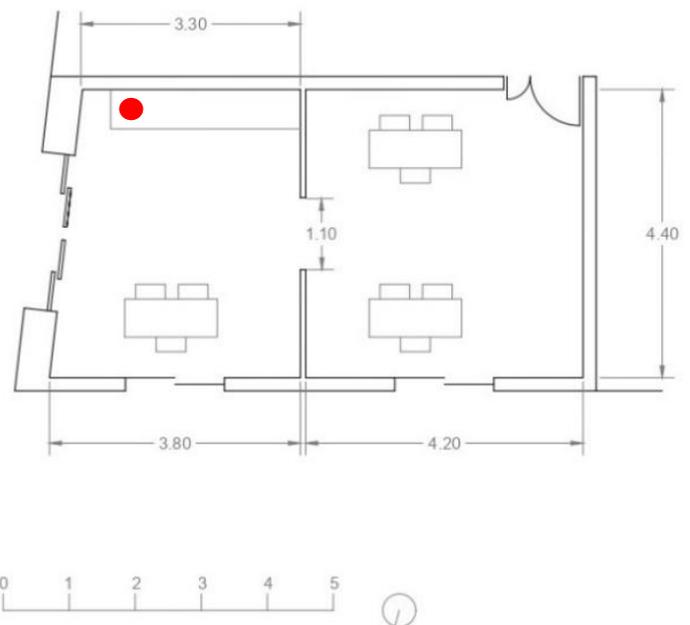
Ubicación del dispositivo en caso A. Fuente: elaborado por el autor. (Imagen y plano)
